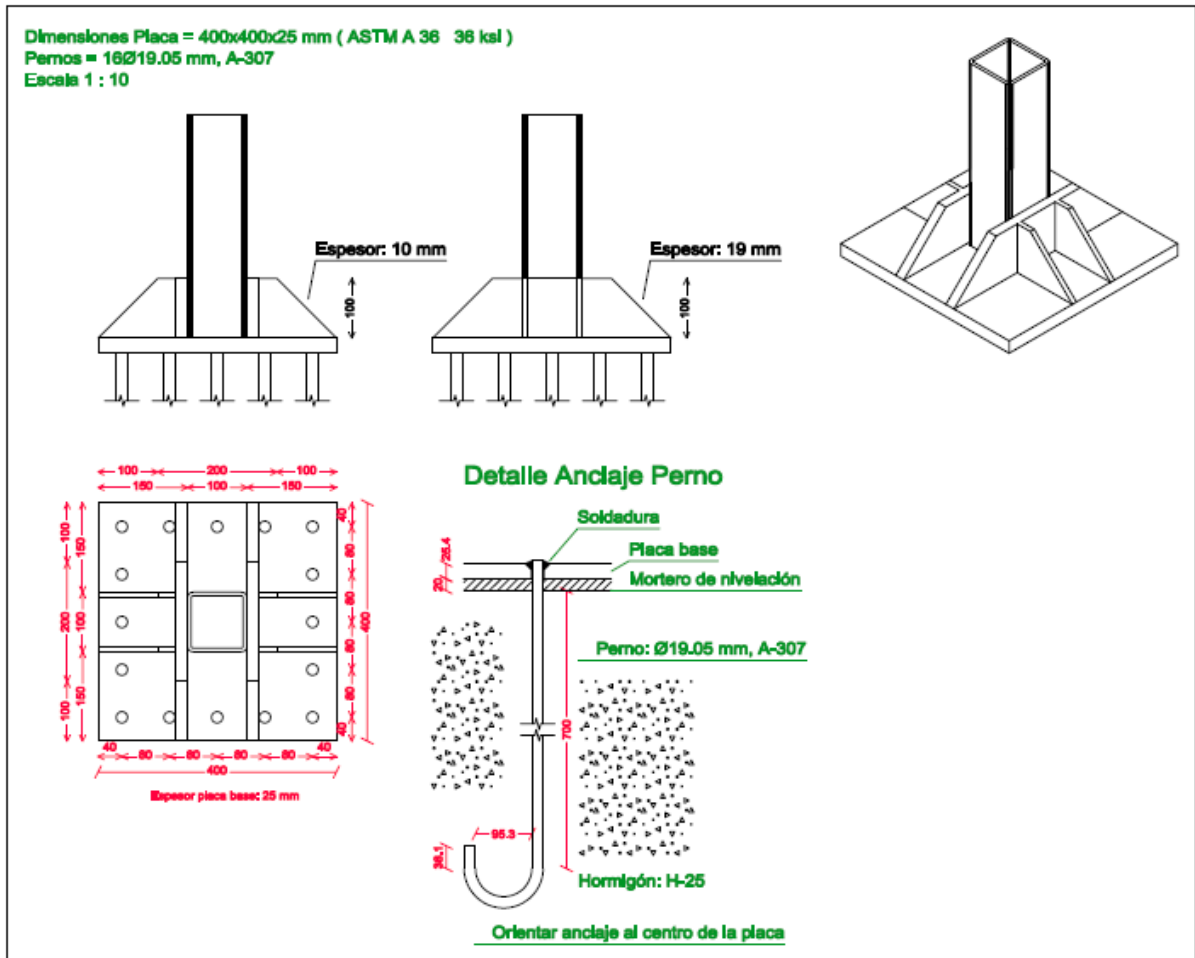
| Detalle de anclaje en bases de hormigón
